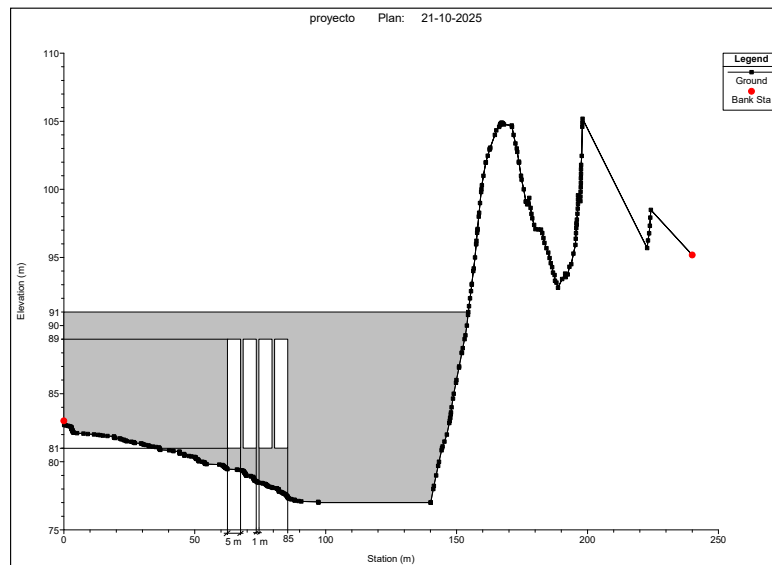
Muro con bocatomas incorporadas al cauce del río Pilmaiquén
